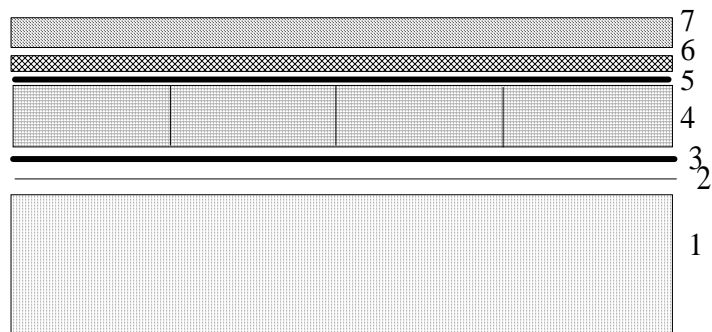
Pose de la plaque isolante sur tôle d'acier nervurée
